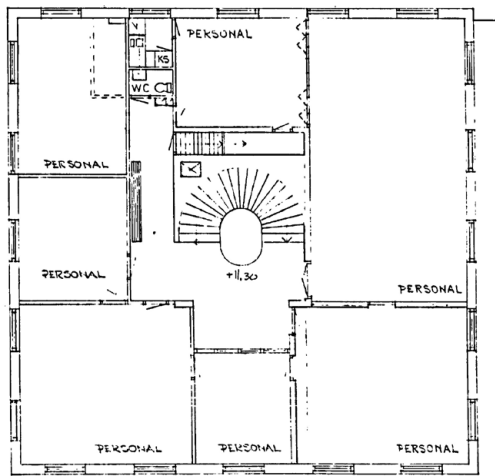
Planritning av Busstornet, ej aktuell planritning.
